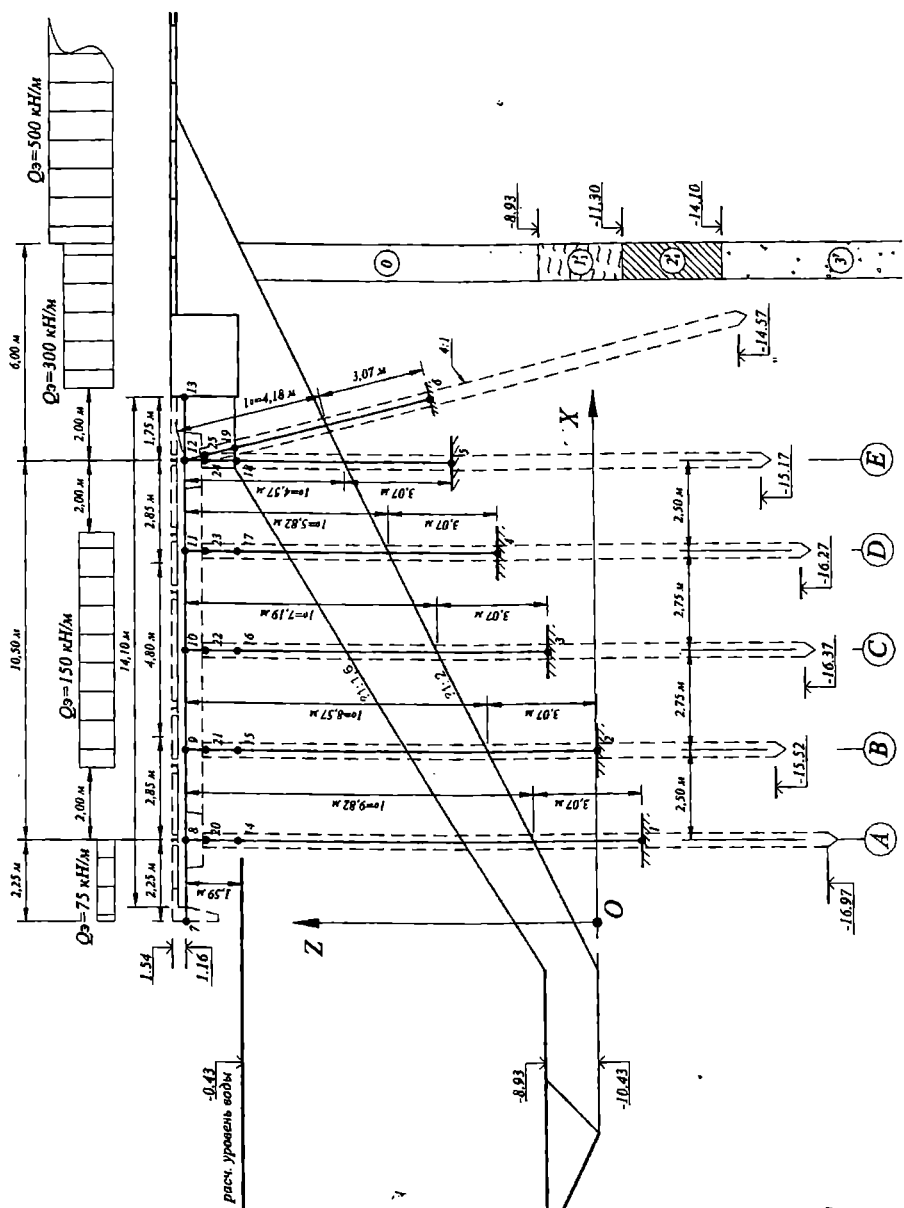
Поперечный разрез набережной-эстакады. Расчетная схема
